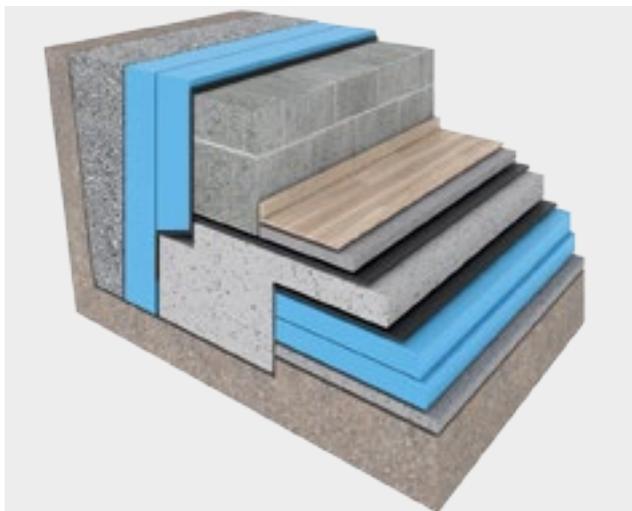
Detailbeispiel Fußpunkt Kelleraußenwand und Wandanschluss
